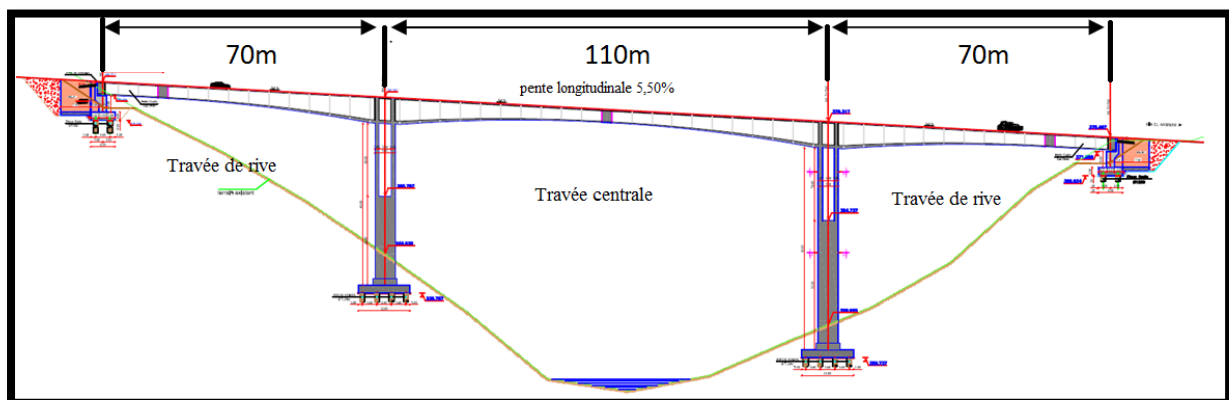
Coupe longitudinale de l'ouvrage.
